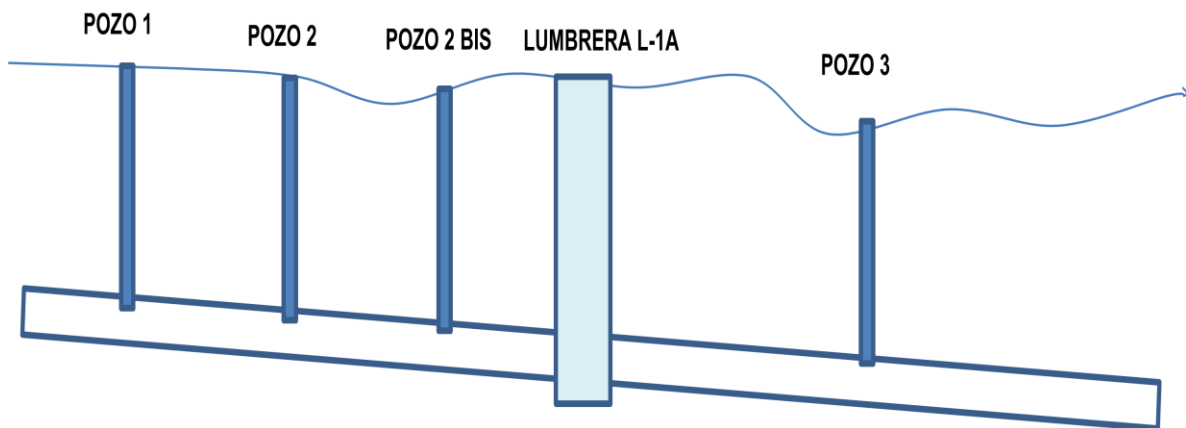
PLAN INTEGRAL DE POZOS DE REZAGA
